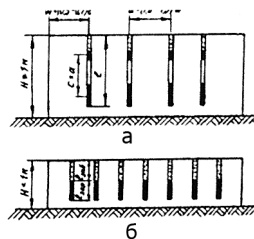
Подрывание железобетонной плиты удлинненным зарядом:
